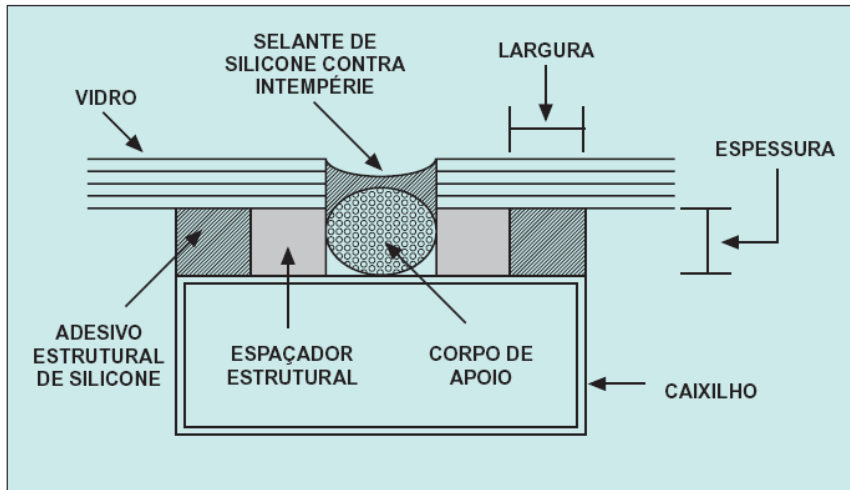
Aplicação de vedante de silicone no corte do perfil
